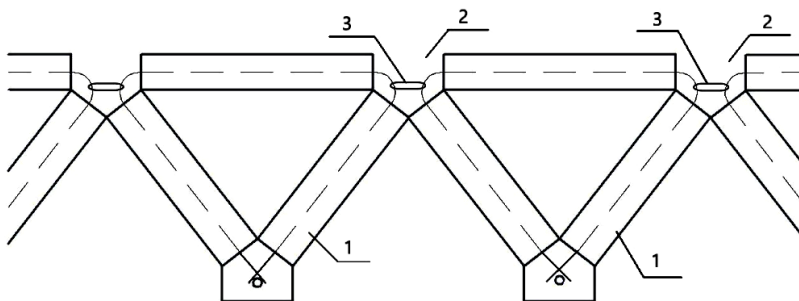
Вариант объединения балок в перекрытии совместным бетонированием верхних узлов балок: 1 – основные элементы балок; 2 – участки перекрытия, подлежащие бетонированию; 3 – хомуты для объединения сеток смежных балок
